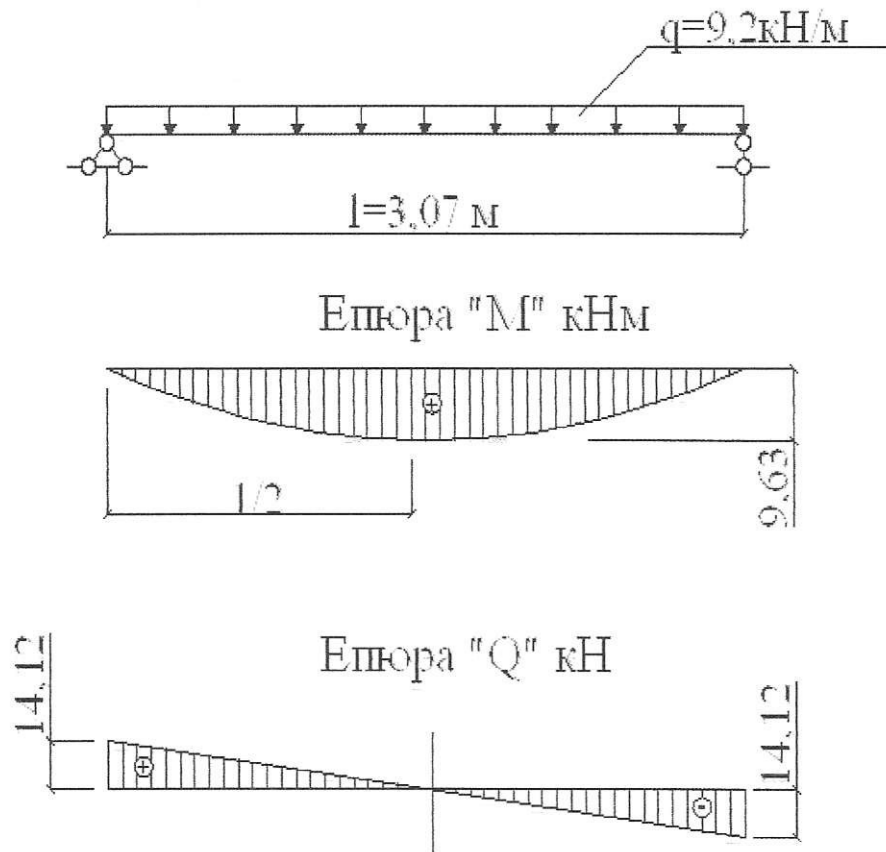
Епюри внутрішніх зусиль в перерізах сходового маршу.
